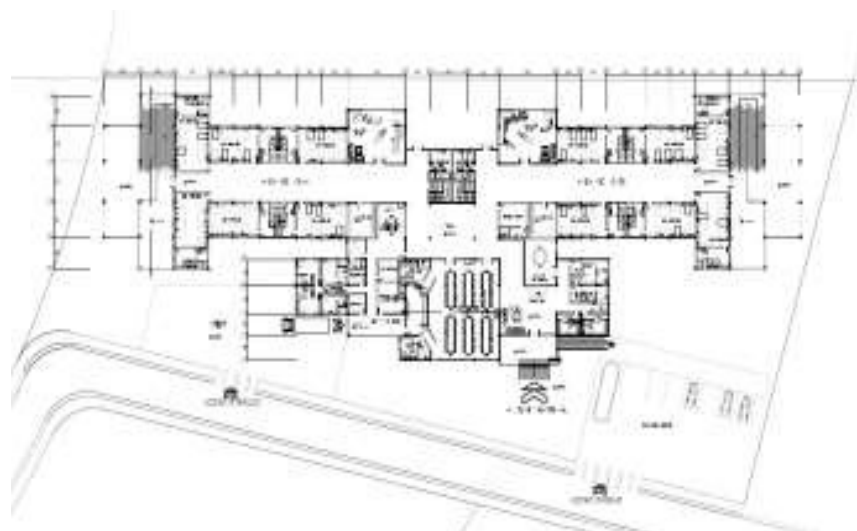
Planta baja conjunto de la Casa Hogar Permanente. (2018)
